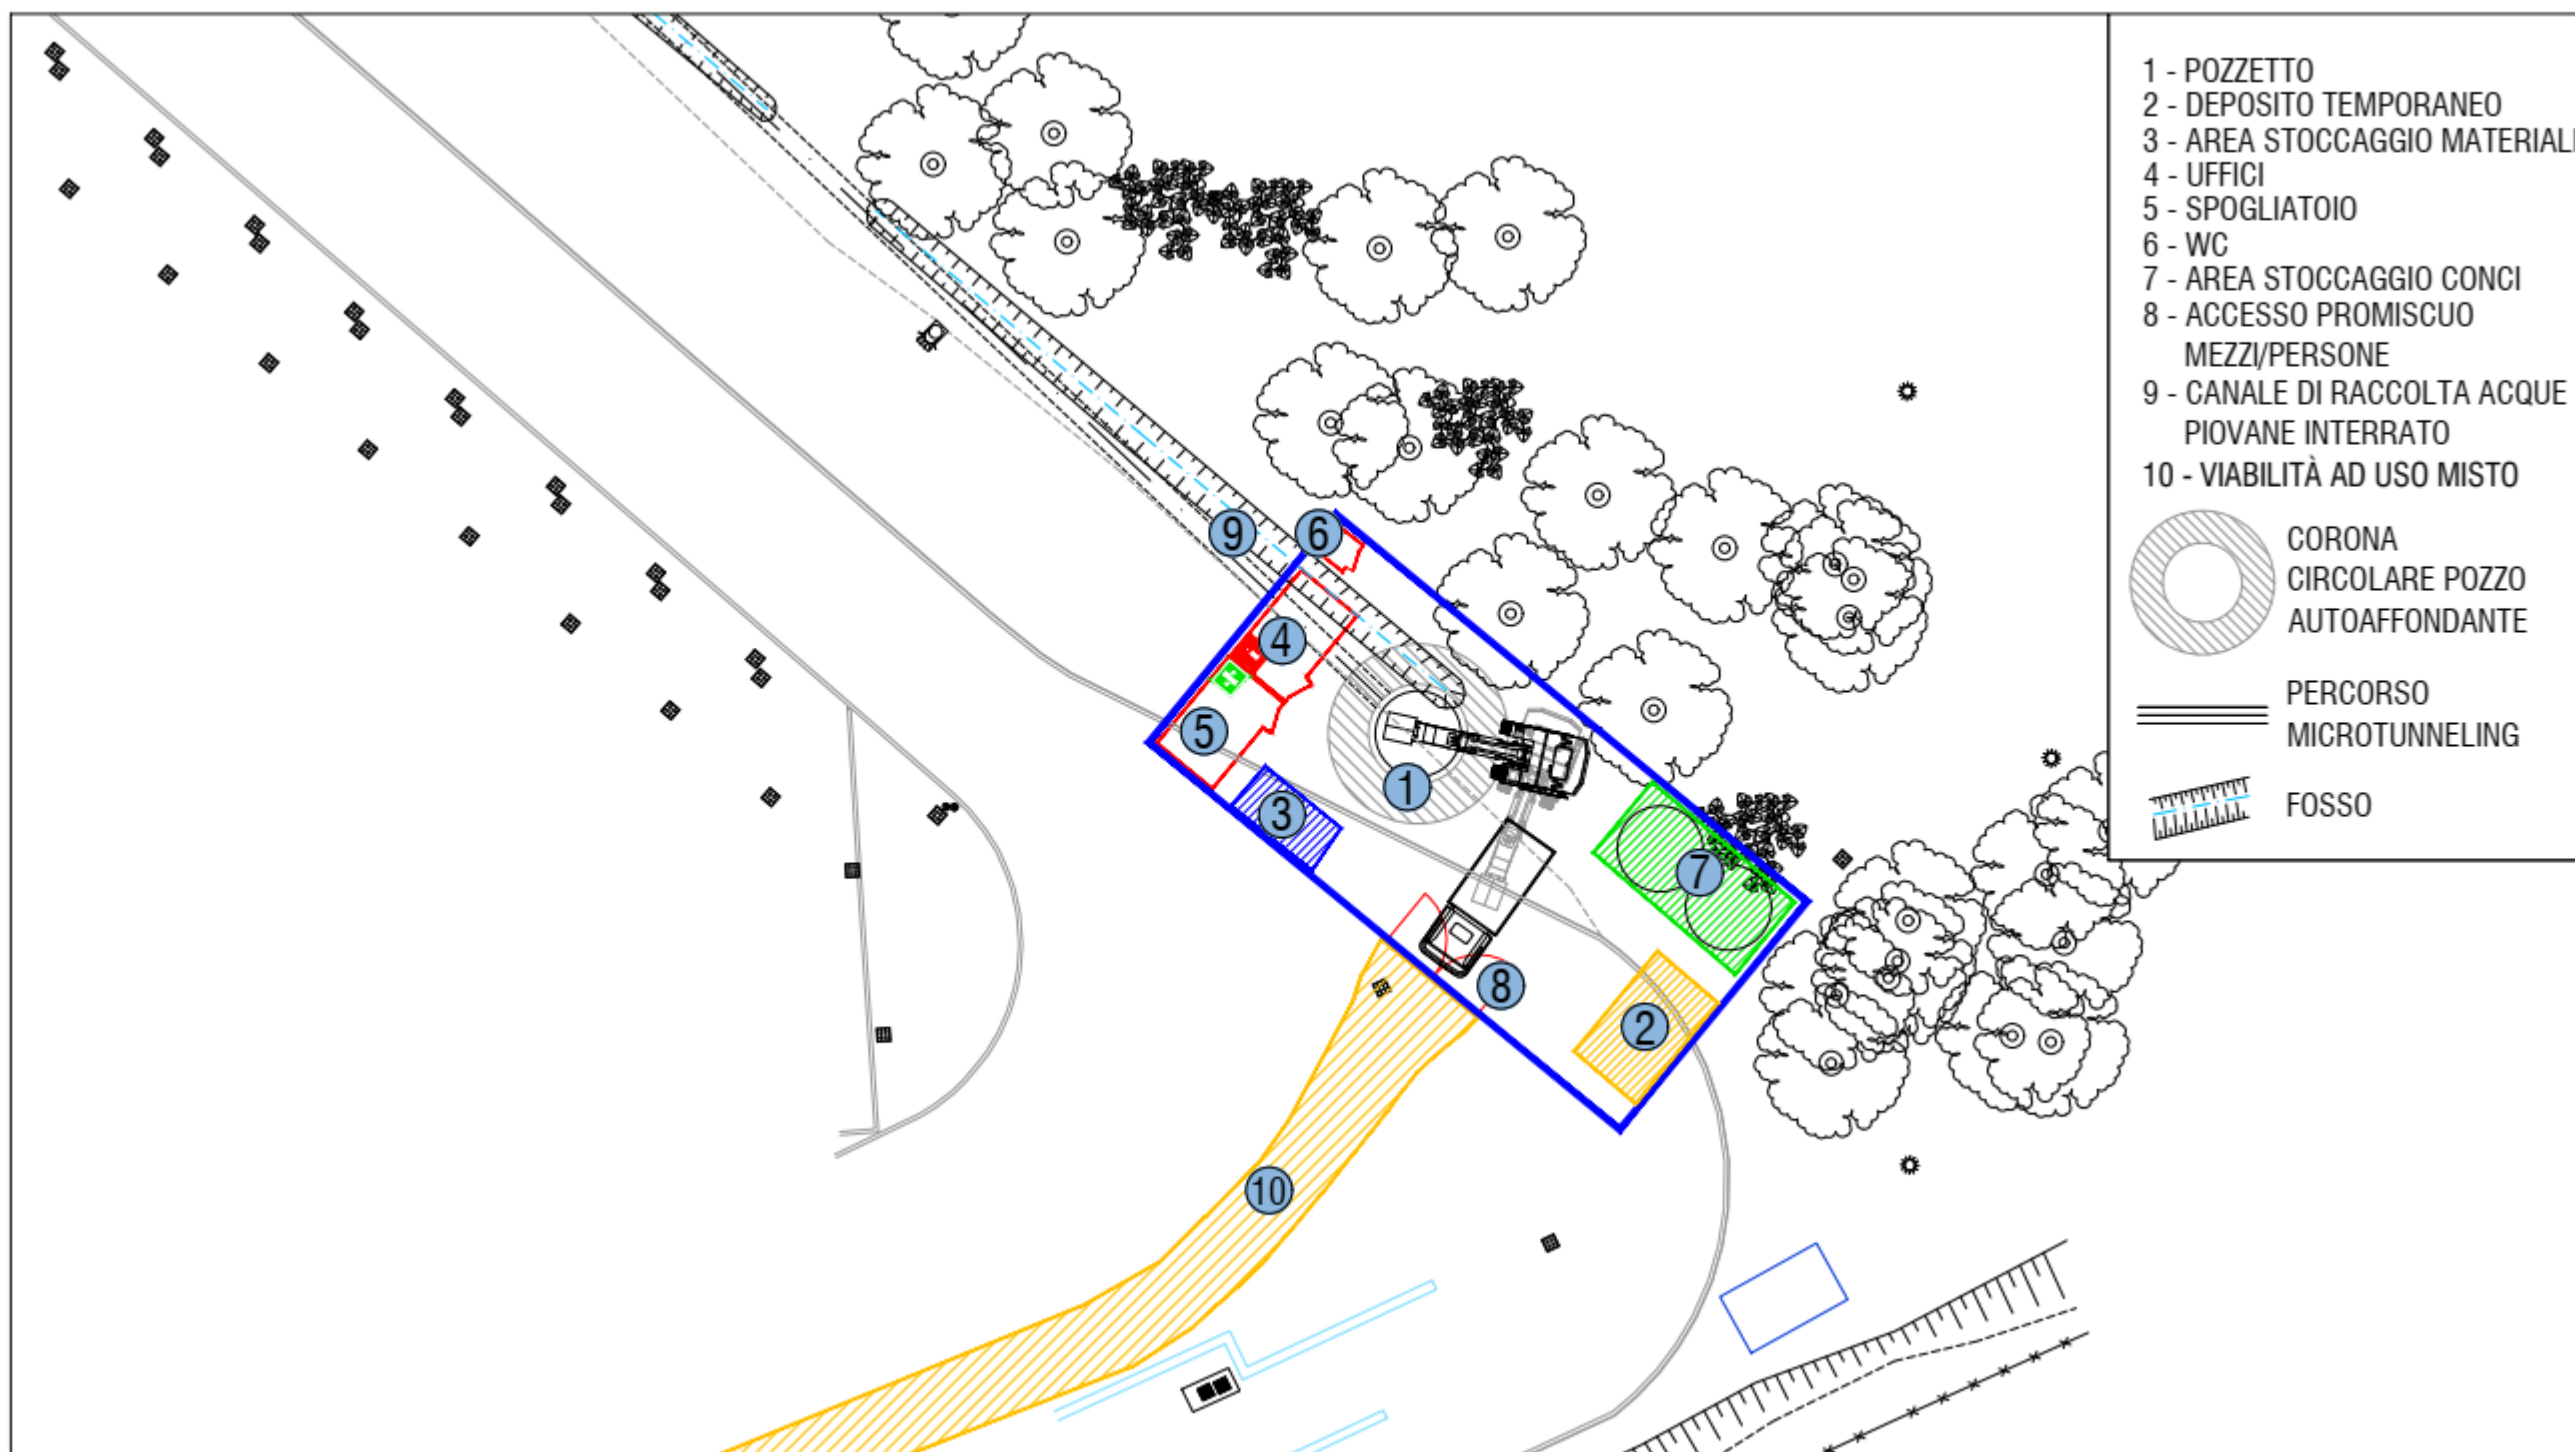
J : Inquadramento planimetrico area cantiere POZZO S02
